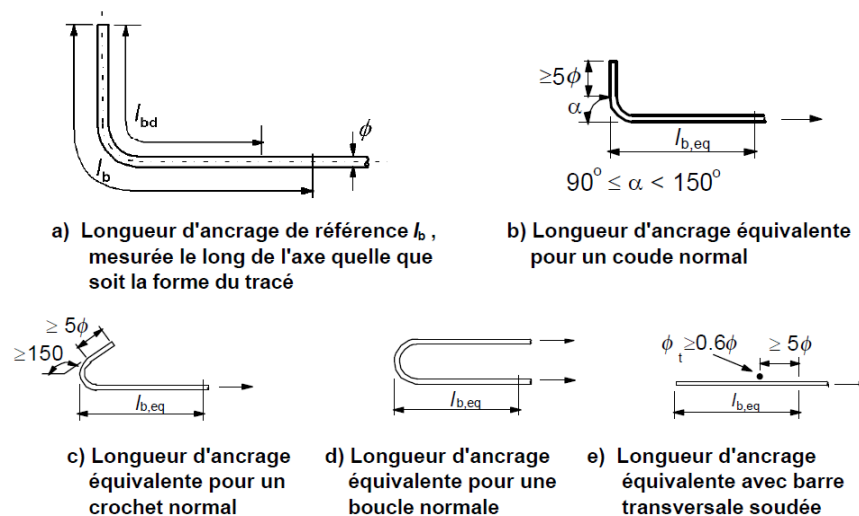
Méthodes d'ancrage autres que le scellement droit
